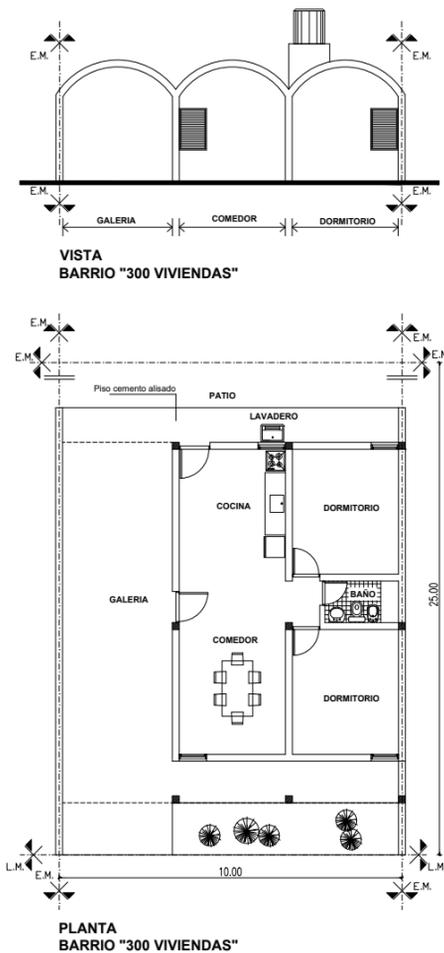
| Planta y vista de la tipología de dos dormitorios.
